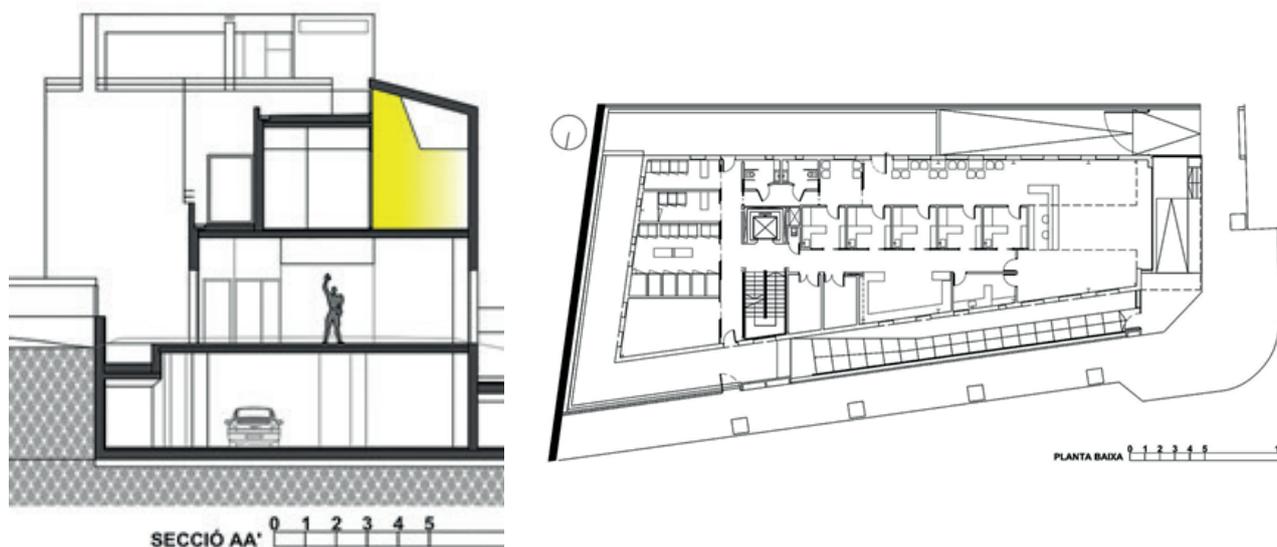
Поперечный разрез и план 1-го этажа [7]
